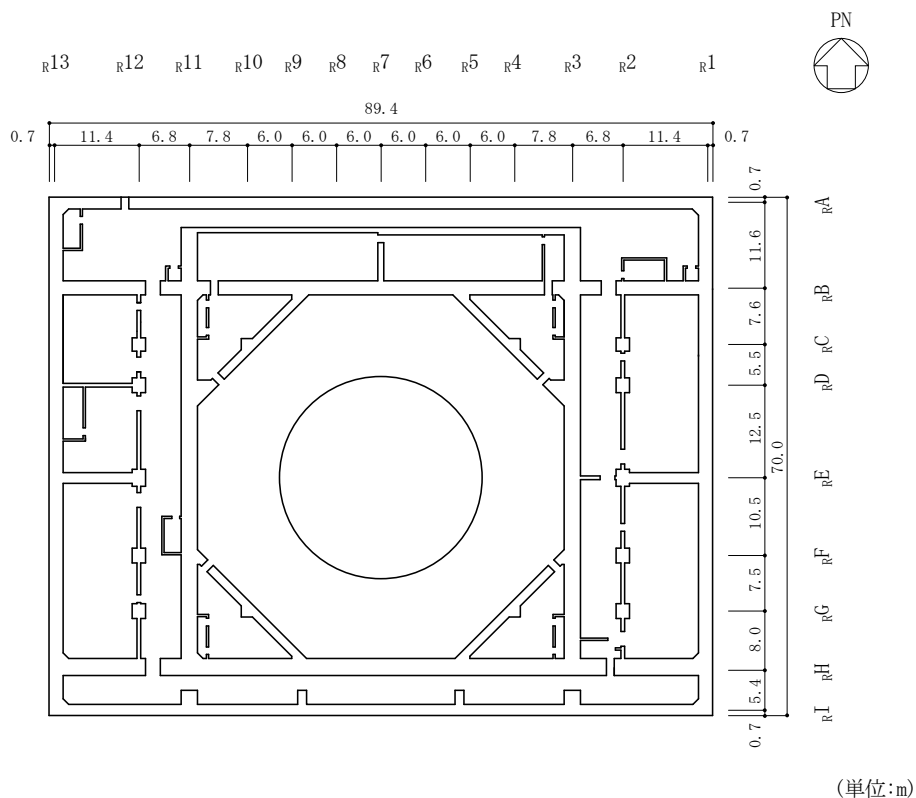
(1) 原子炉建物の概略平面図 (EL 1.3m*)
